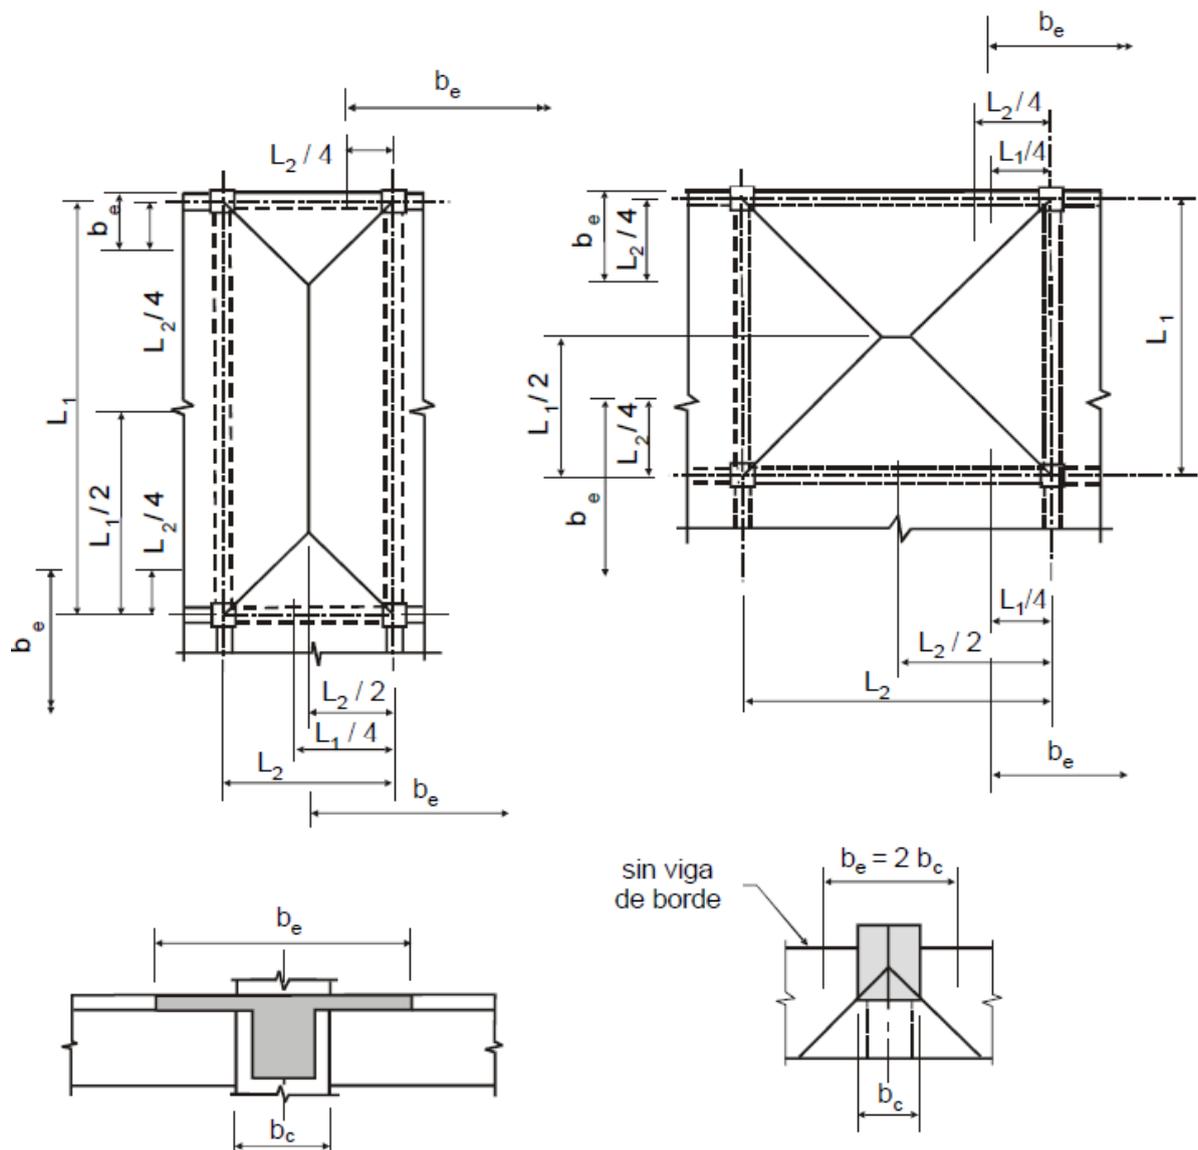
Anchos efectivos de alas traccionadas de vigas con momento negativo para losas coladas in situ.
